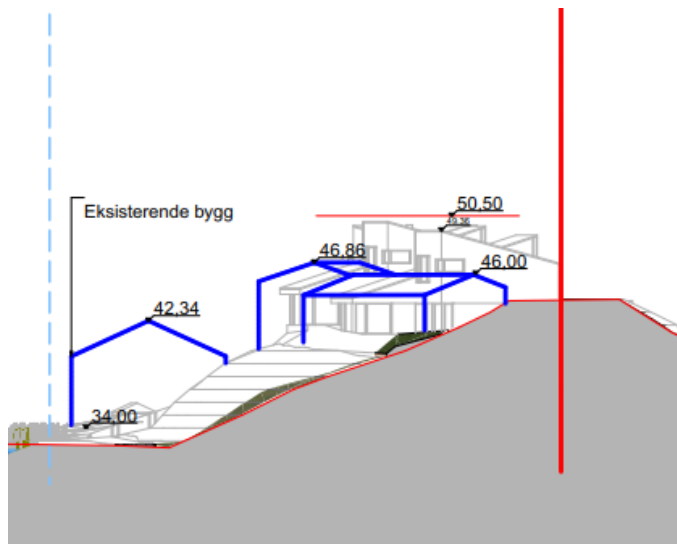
Snitt Ff. Blå stiplet linje viser eksisterende byggehøyde. Til venstre er felt BF1, til høyre felt BB.
